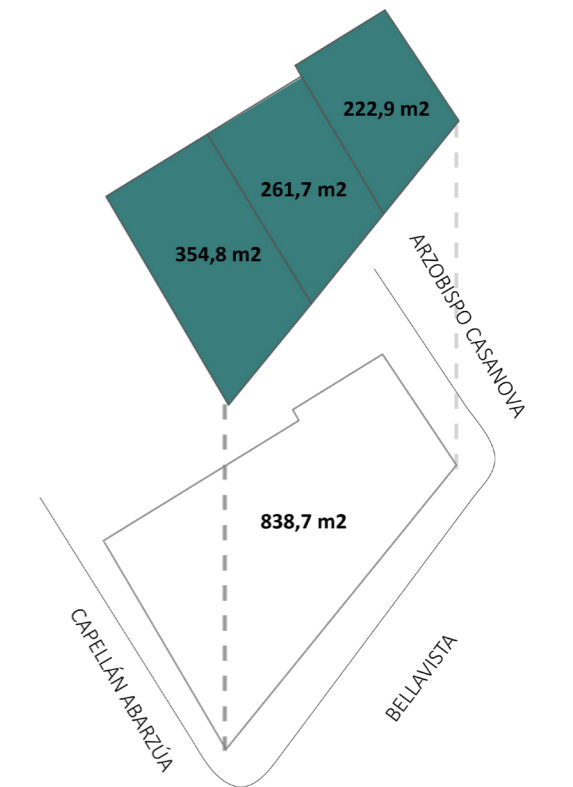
Planta de terreno a intervenir con m2 de cada predio.
